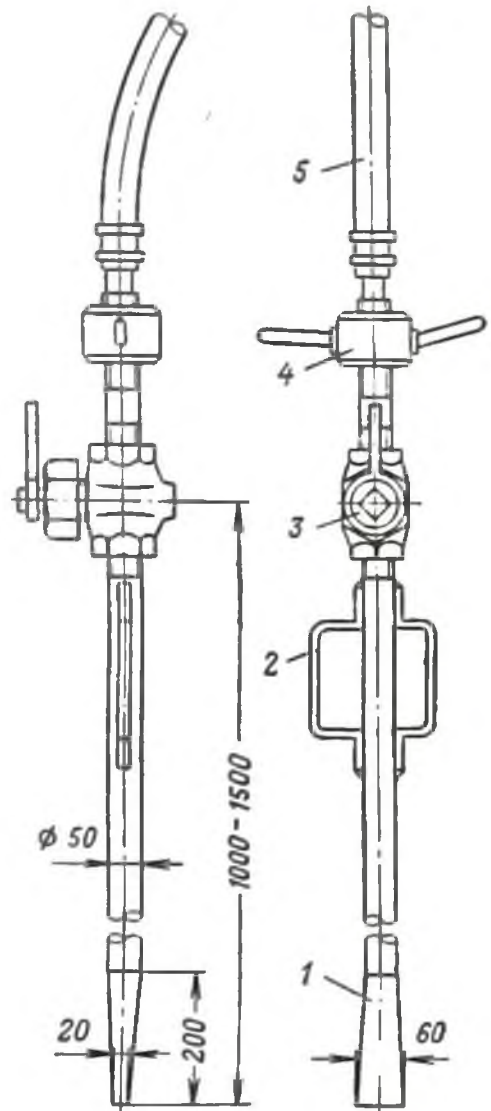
Пневмомонитор ручного типа для зачистки забоя сжатым воздухом:
